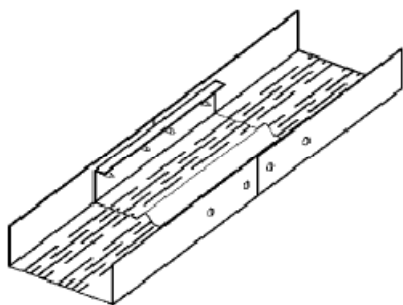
Кріплення на з'єднувальних елементах і болтах
